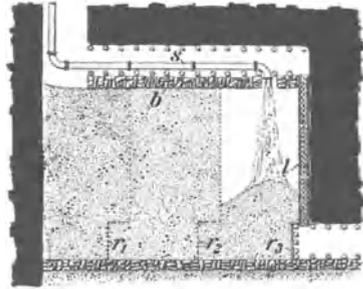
Spulversatz mit Riegeldammen und gelochten Wetterlutton auf Zeche Deutscher Kaiser.
